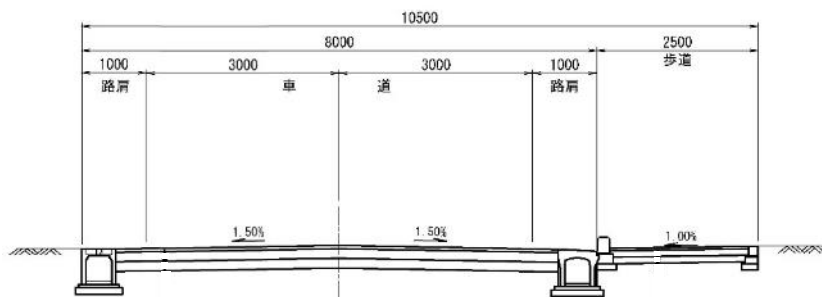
(2) 標準断面図 (区画道路 幅員 10.5m)
